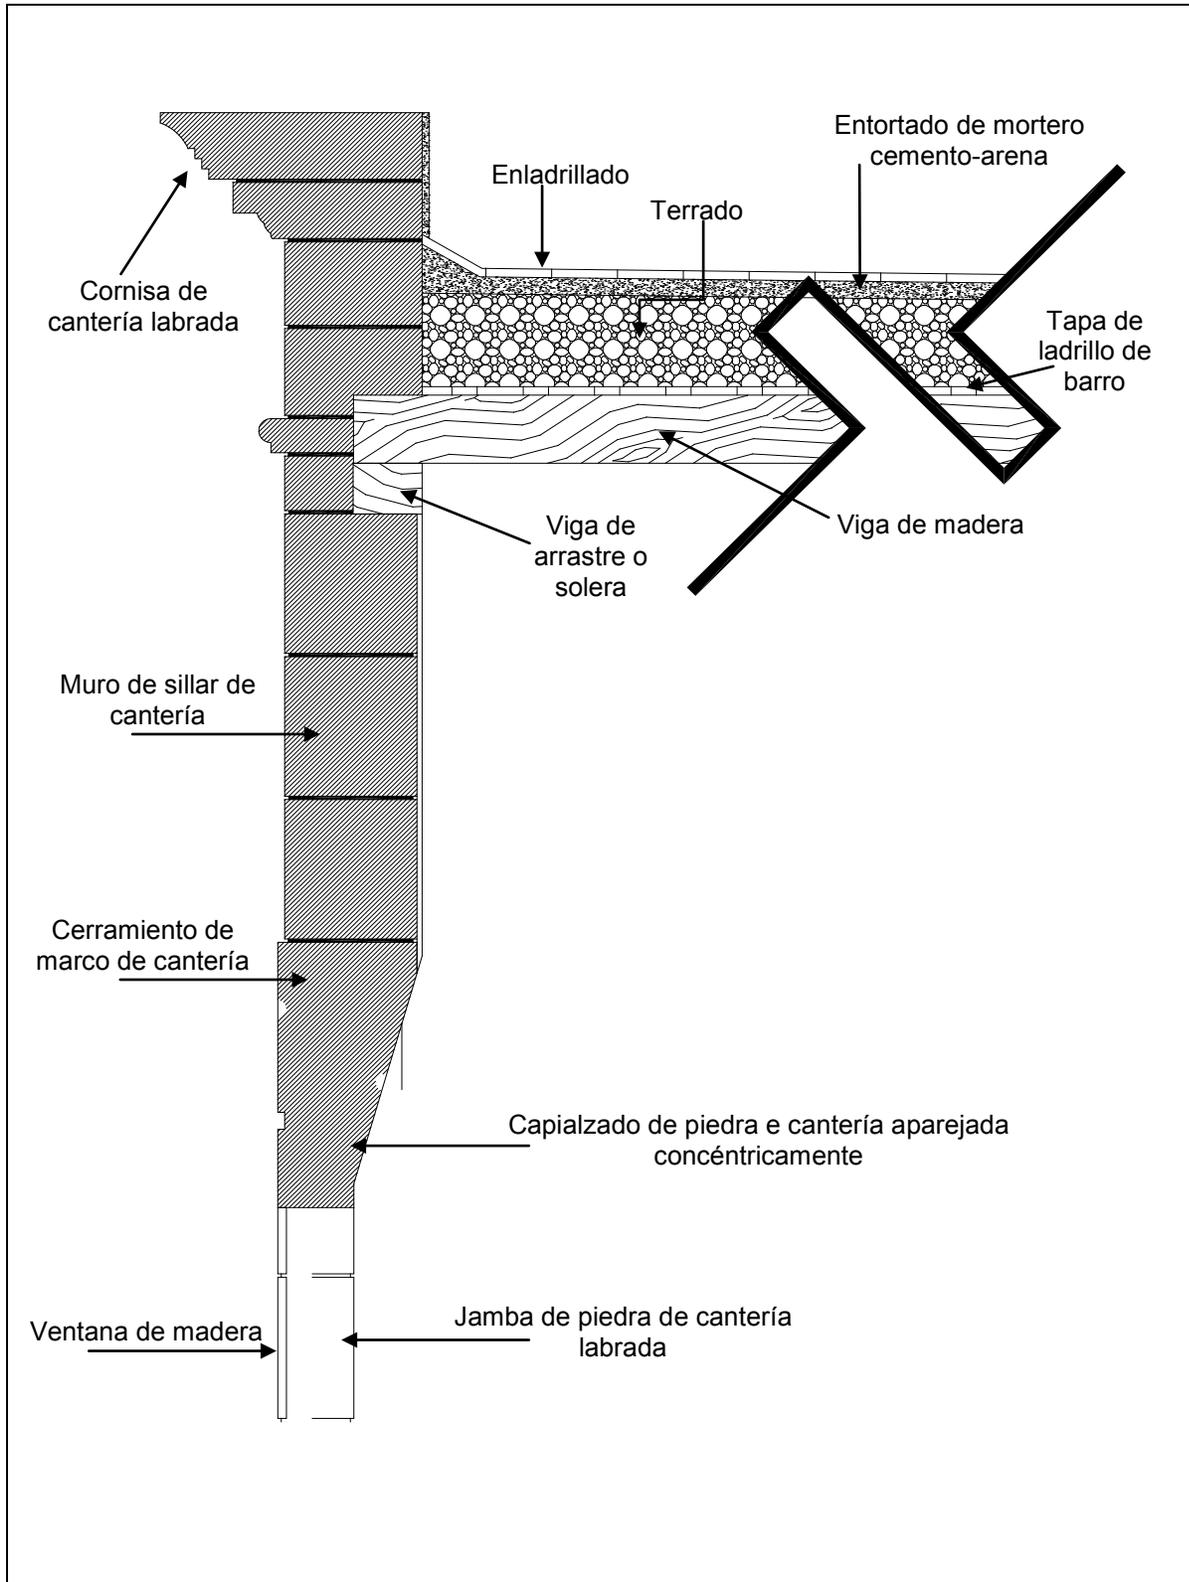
Corte por fachada tipo de las unidades de análisis donde se detalla la cubierta.
